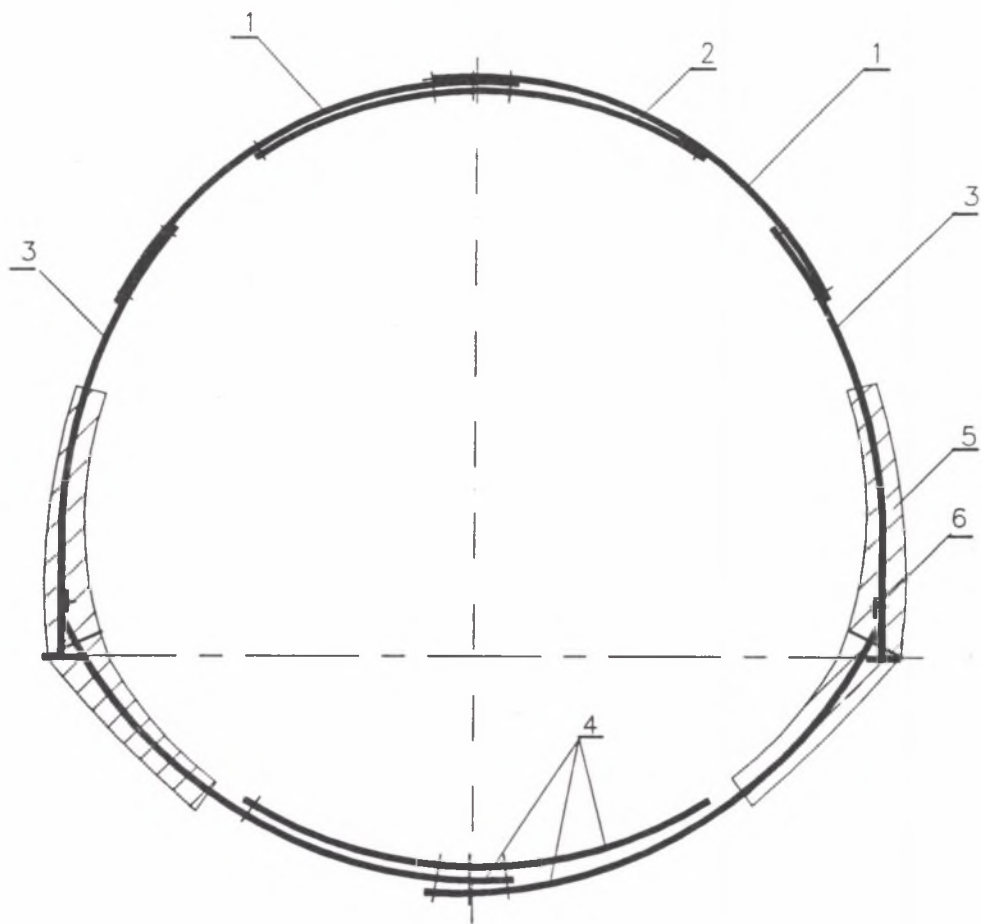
Odrzwaia obudowy LP o konstrukcji wzmoconionej 1 - dwuelementowy łuk stropowy, 2 - dodatkowy łuk stropowy, 3 - łuk ociosowy, 4 - kotew, 5 - beton
